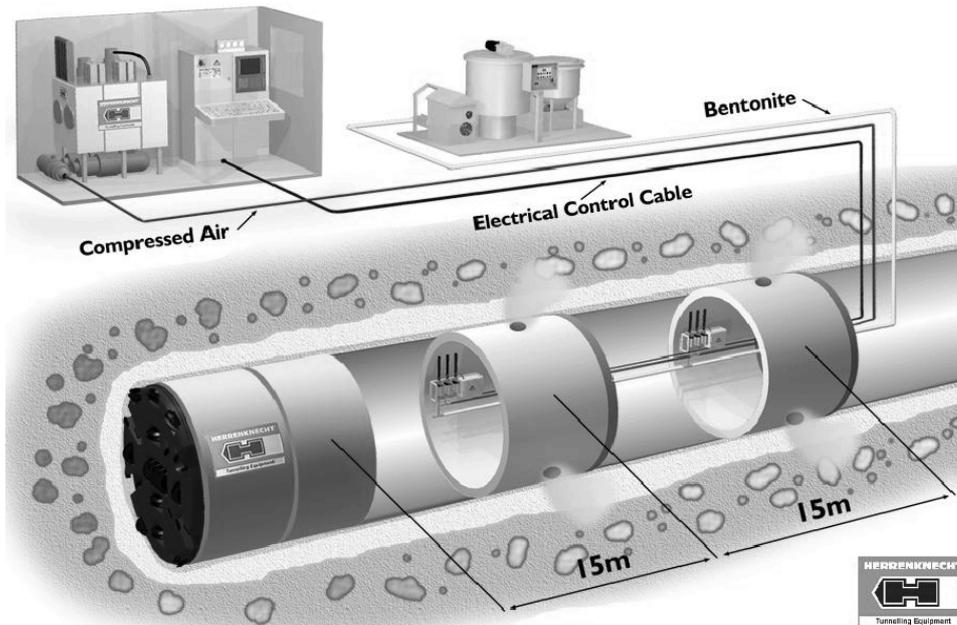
Baustelleneinrichtung zur Bentonitschmierung [14]
